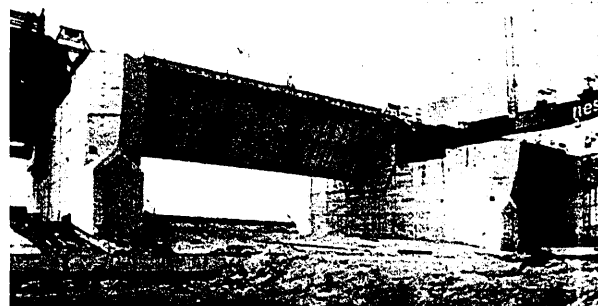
ª. — Construcción de las esclusas de desagüe llegando a su término.
